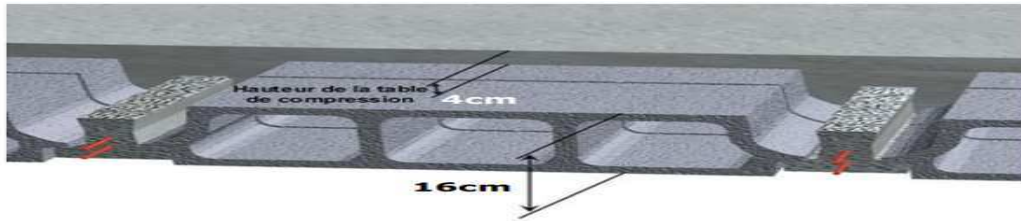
Schéma explicatif d'un plancher à corps creux.
